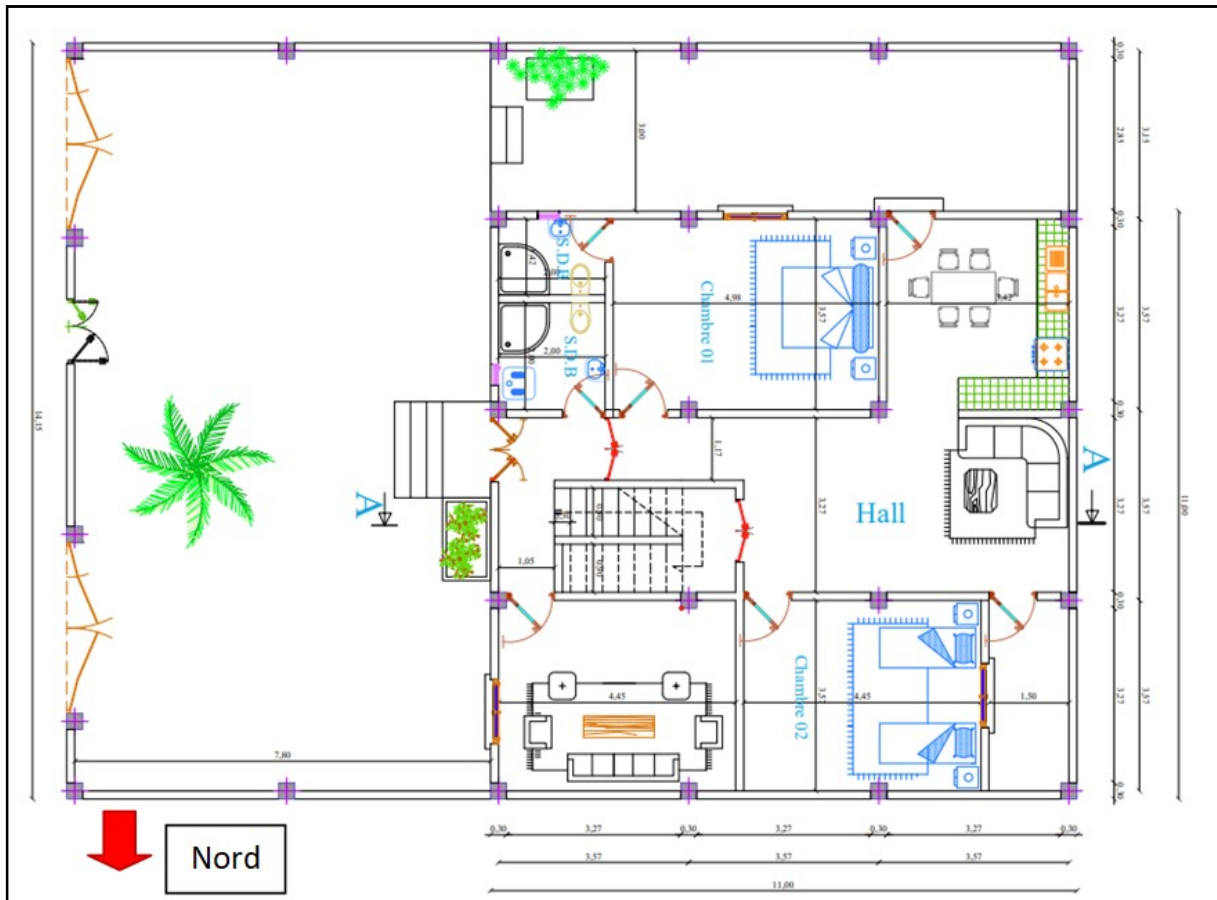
Plan architectural de maison .Source : BTP RAOUDI.
